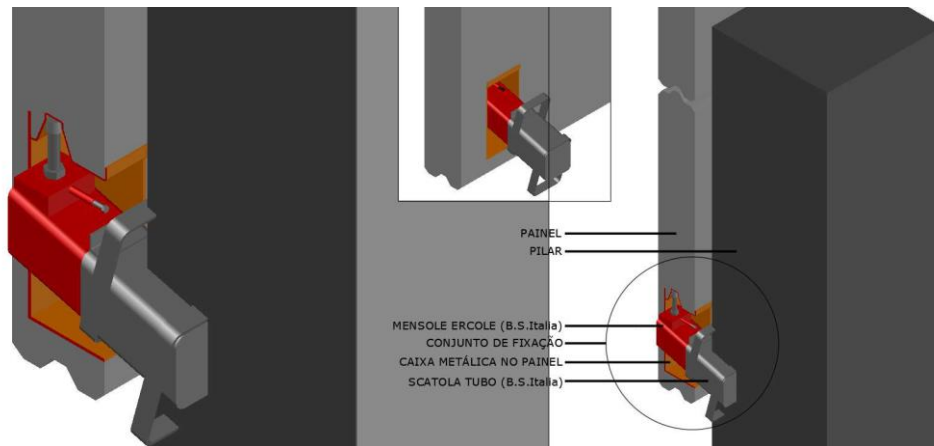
Pormenor de fixação de um painel pré-fabricado suspenso (José Rui Pinto, 2021)
